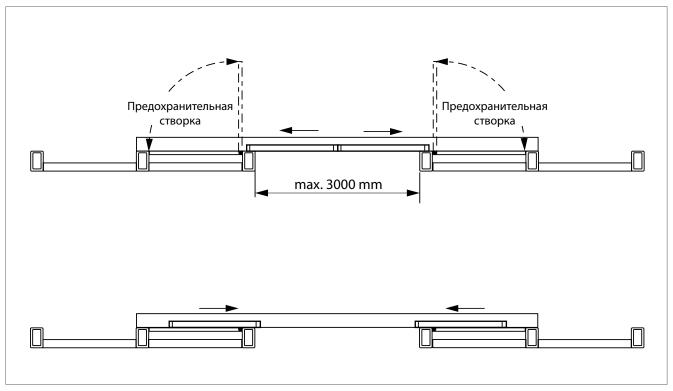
· Вариант установки на фасадной конструкции, 2 створки, с предохранительной створкой
